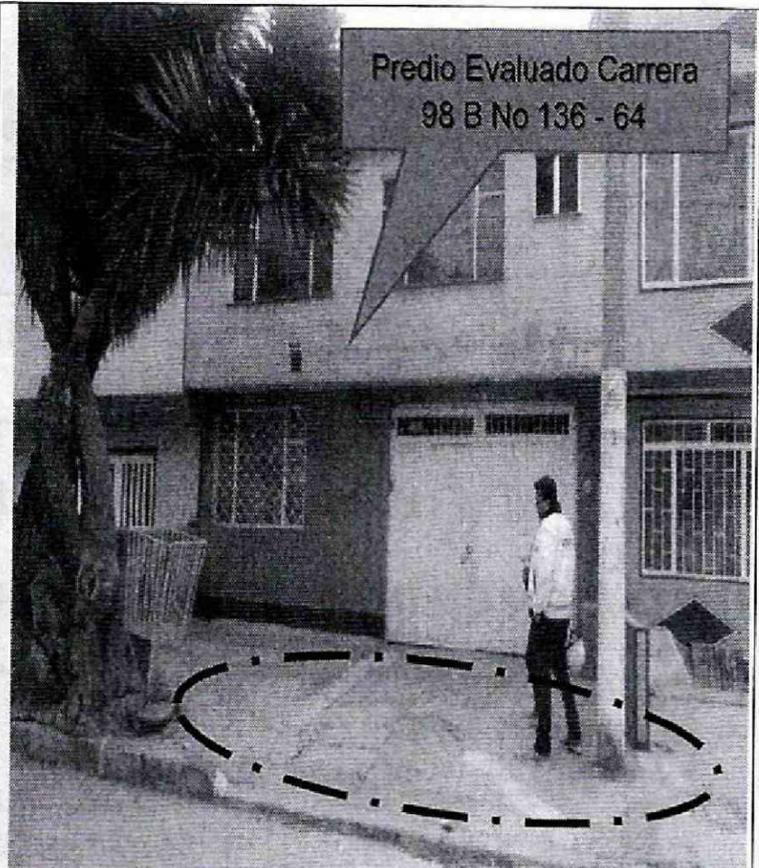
Fisuras y fracturas identificadas en andén peatonal en el sector comprendido entre la Carrera 98 B costado oriental.
